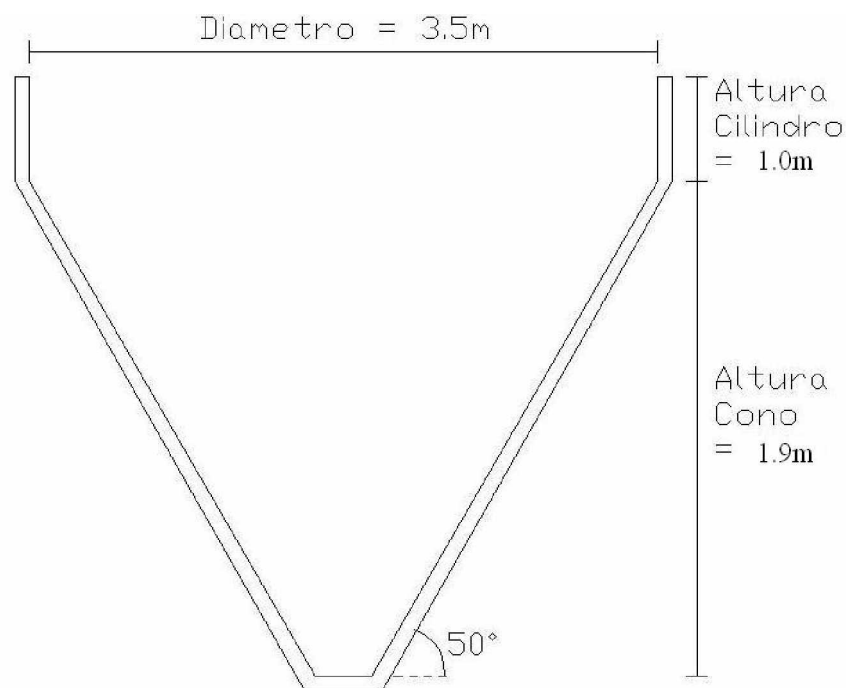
Sección del sedimentador secundario de la Planta N°2
